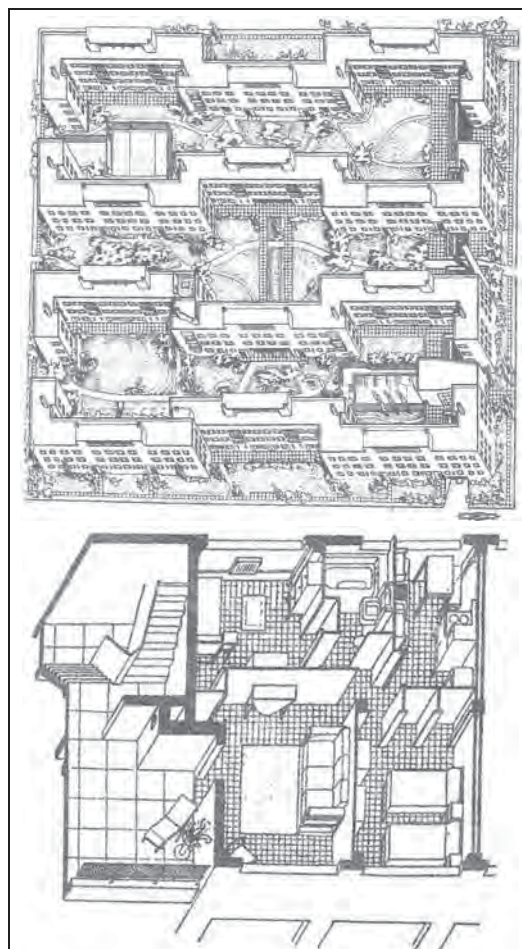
Vivienda Mínima, planta arquitectónica y organización en conjunto.
